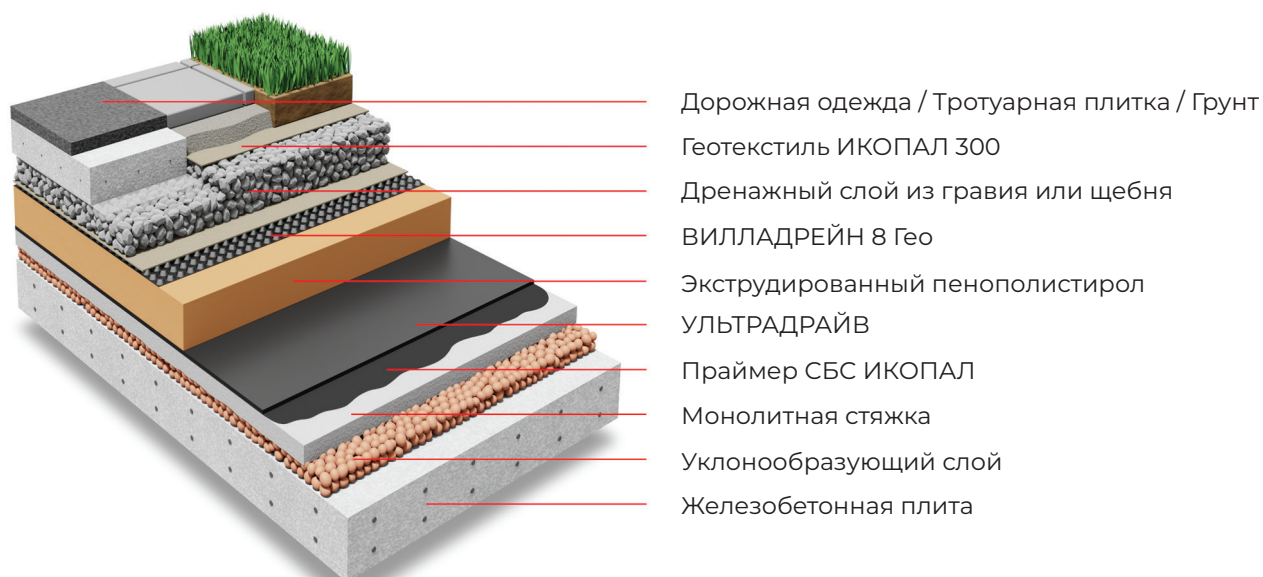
Вариант инверсионной эксплуатируемой кровли с однослойным кровельным ковром
